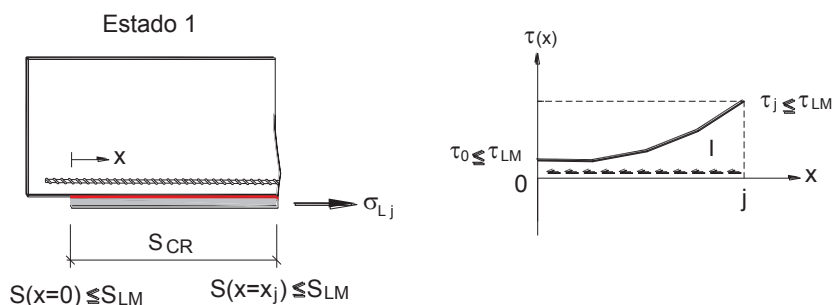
Distribución del esfuerzo cortante en un elemento de viga ubicado entre el extremo de la platina FRP y la grieta  $j$  más cercana, en el estado 1.
